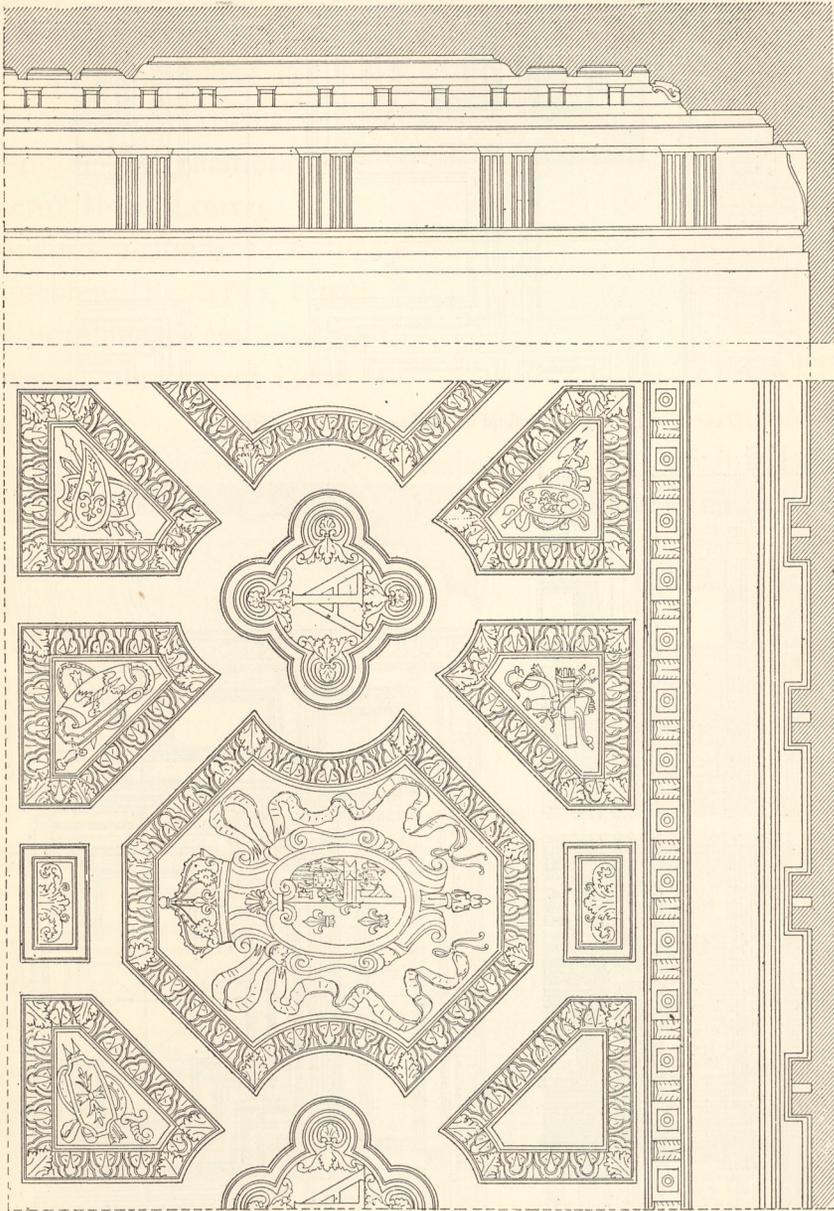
Plafond du grand salon des appartements du Pape, à Fontainebleau.
